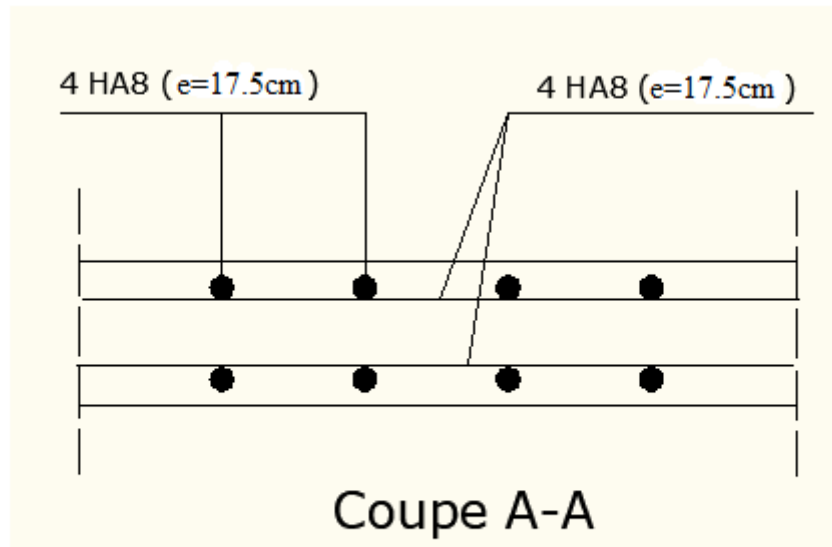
Plan de ferrailage de l'acrotère.
